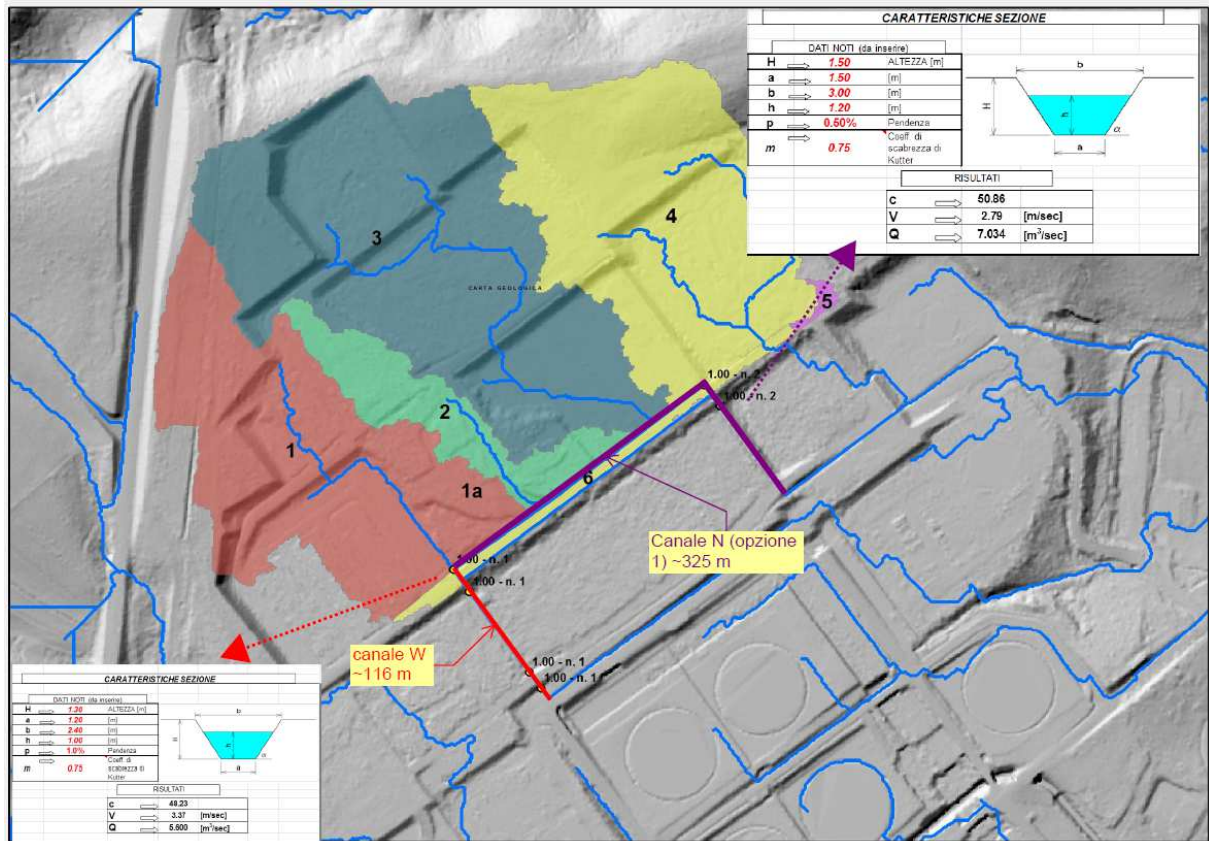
Posizionamento planimetrico opere di regimazione idraulica
